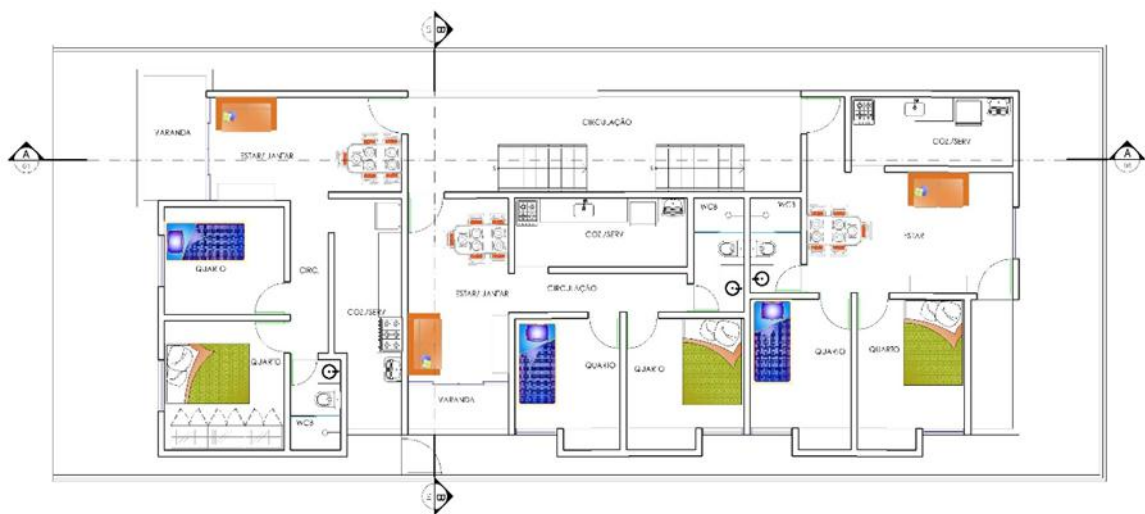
Planta baixa pavimento superior proposta final. Fonte: acervo próprio.
